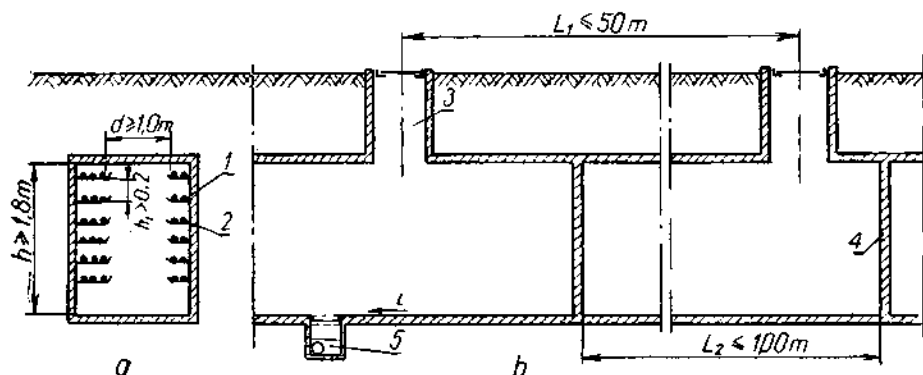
Tunel de cabluri: a — secțiune transversală cu distanțe minime; b — secțiune longitudinală cu distanțe minime; 1 — cablu; 2 — raft sau console; 3 — cămin de vizitare; 4 — perete transversal pentru evitarea propagării incendiului (perete anti-foc); 5 — sifon de pardoseală
